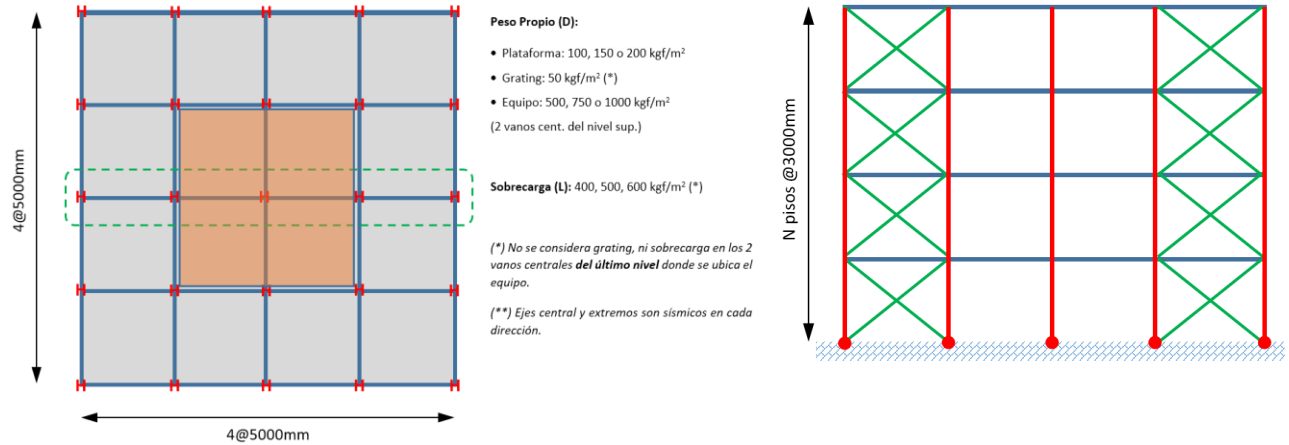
(Izq.) Planta típica y sobrecargas estáticas. (Der.) Elevación típica.
